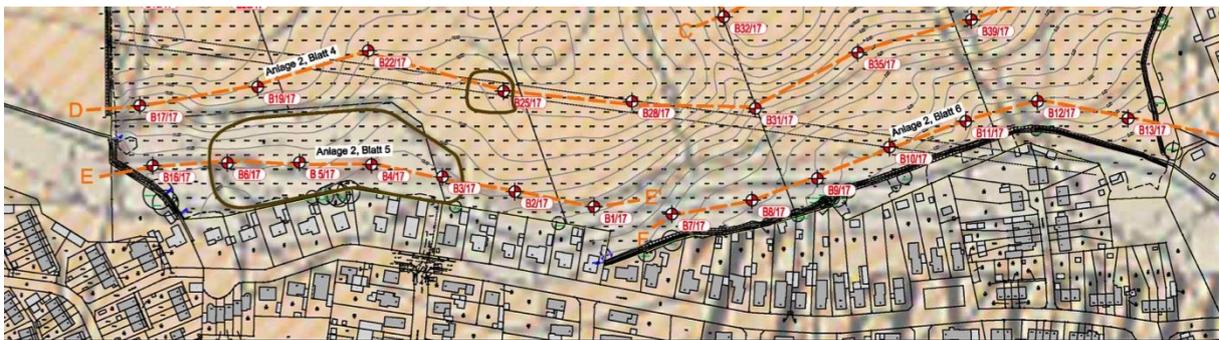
Lageplan mit Untersuchungspunkten, Bereiche mit Torf- Mudden und Torfen im westlichen Plangebiet (Lehnert + Wittorf 2017)
